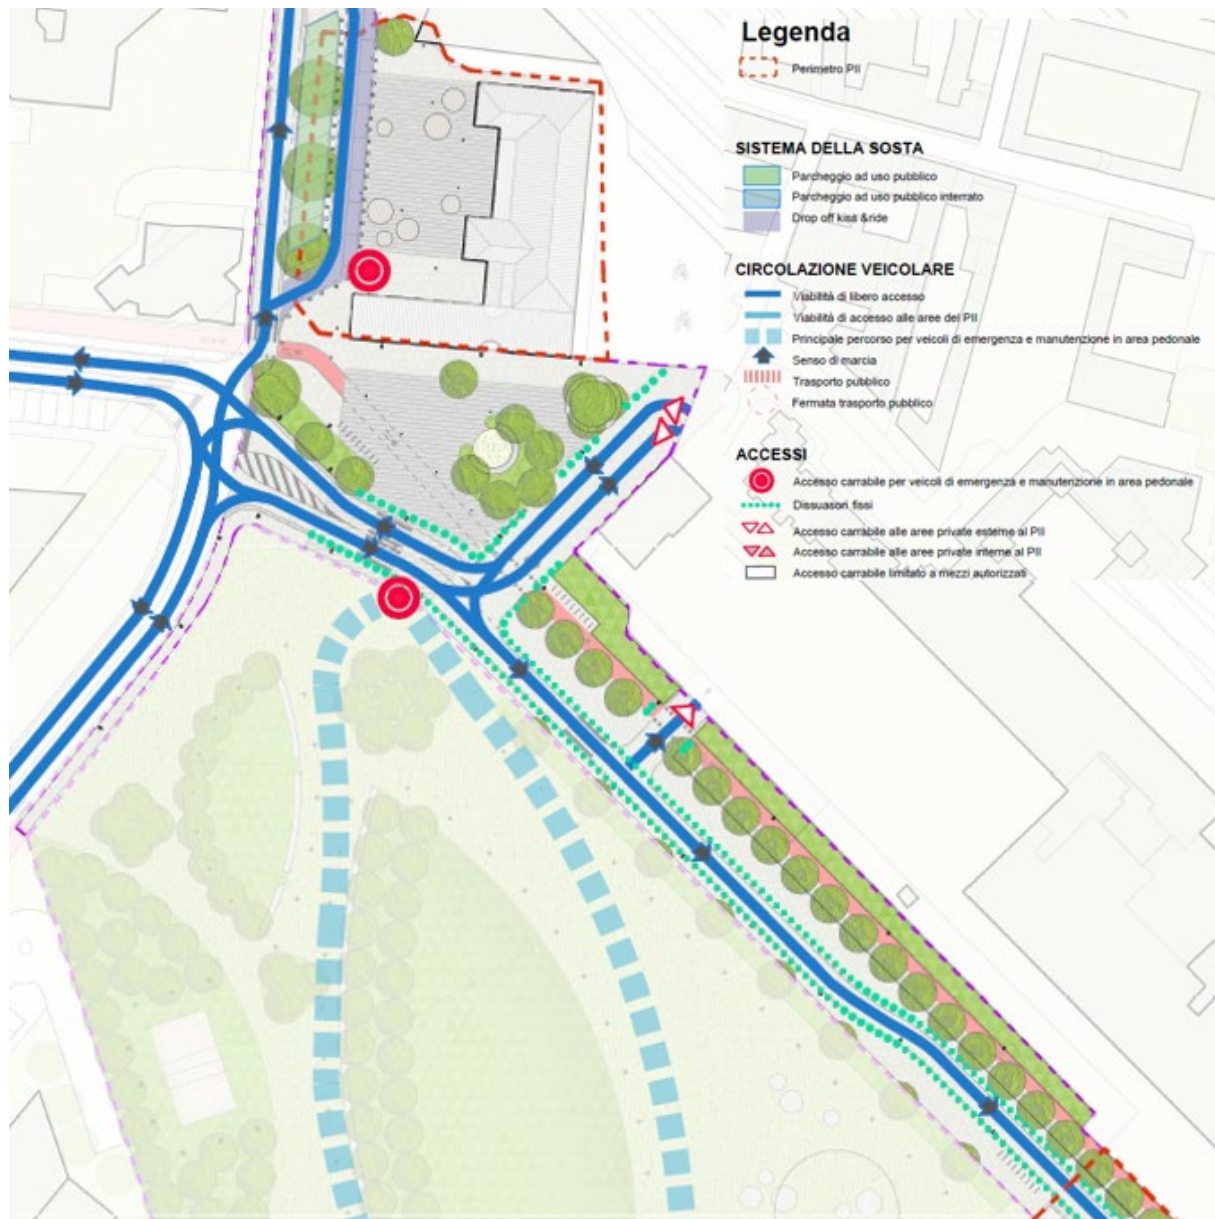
Schema di circolazione IN-OUT da carrai delle autovetture
